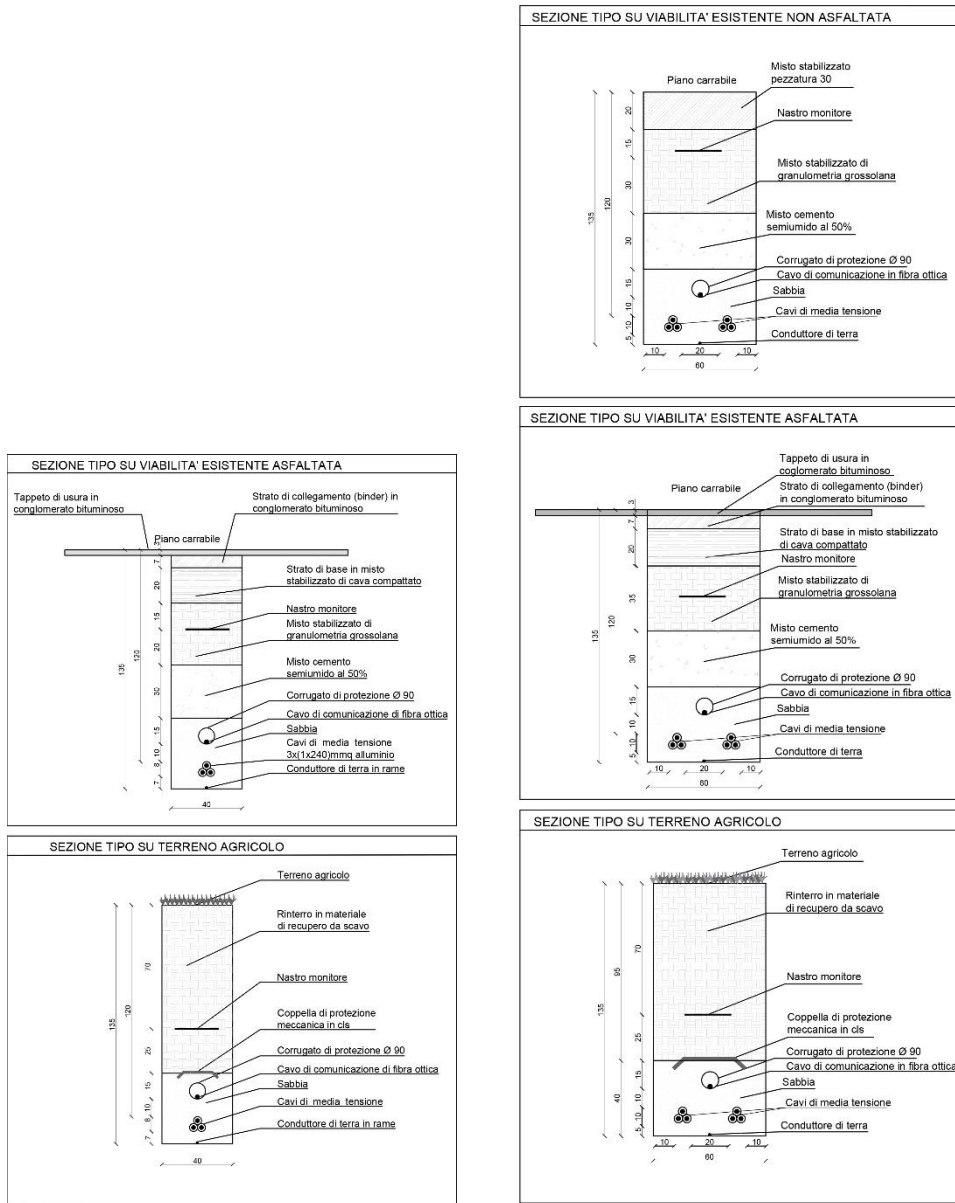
Particolari Sezione cavidotto MT - rif. AR07.2.1
